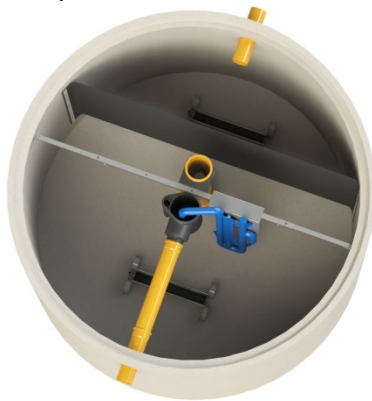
Nachrüstung einer Einkammergrube mit KLARO One
